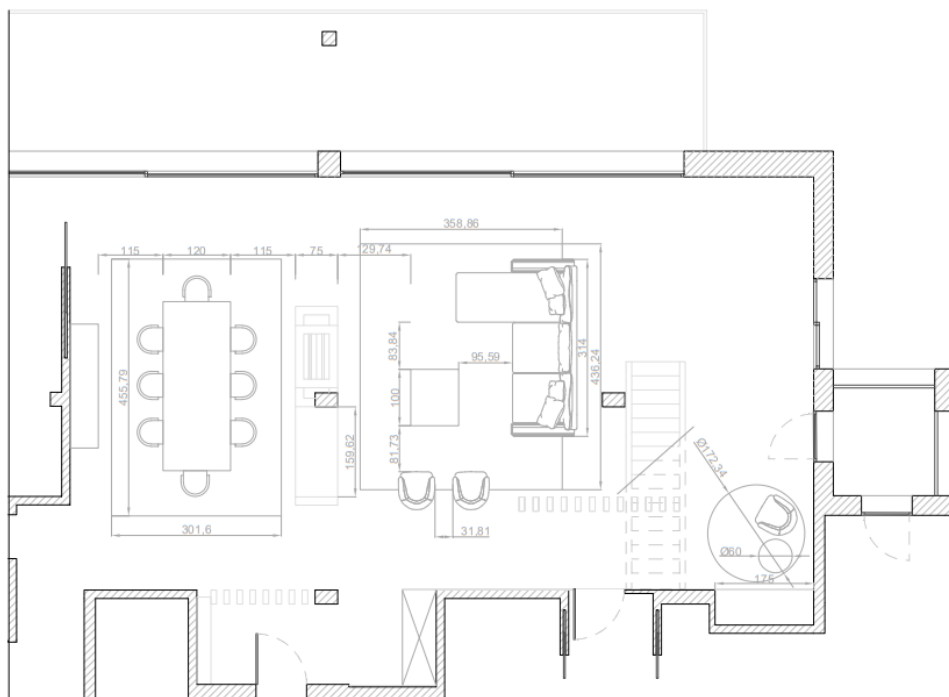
Planta de Equipamento Cotada (da área em estudo)
